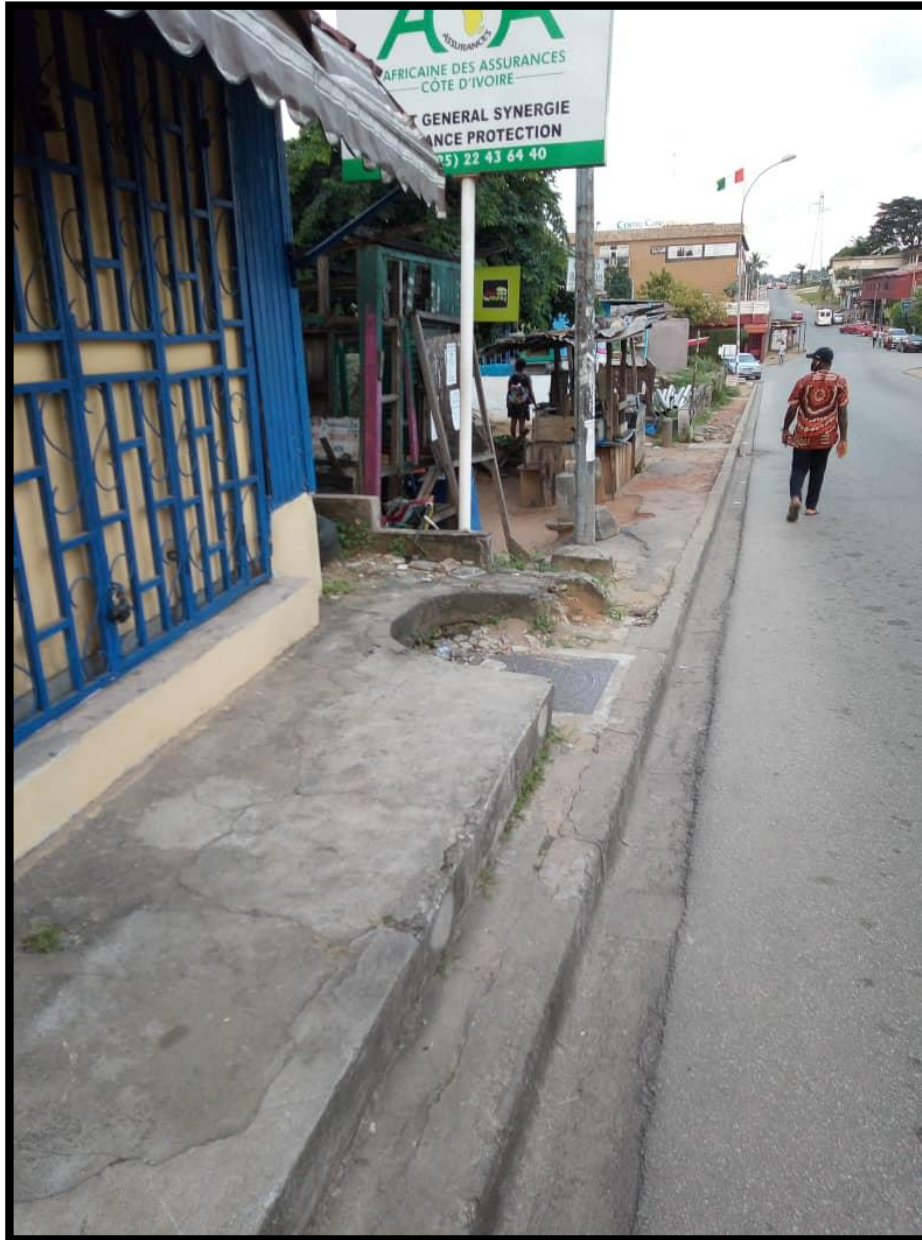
Vue du côté est de la cité donnant sur la voie allant vers la cité Allabra, secteur riviera 2
